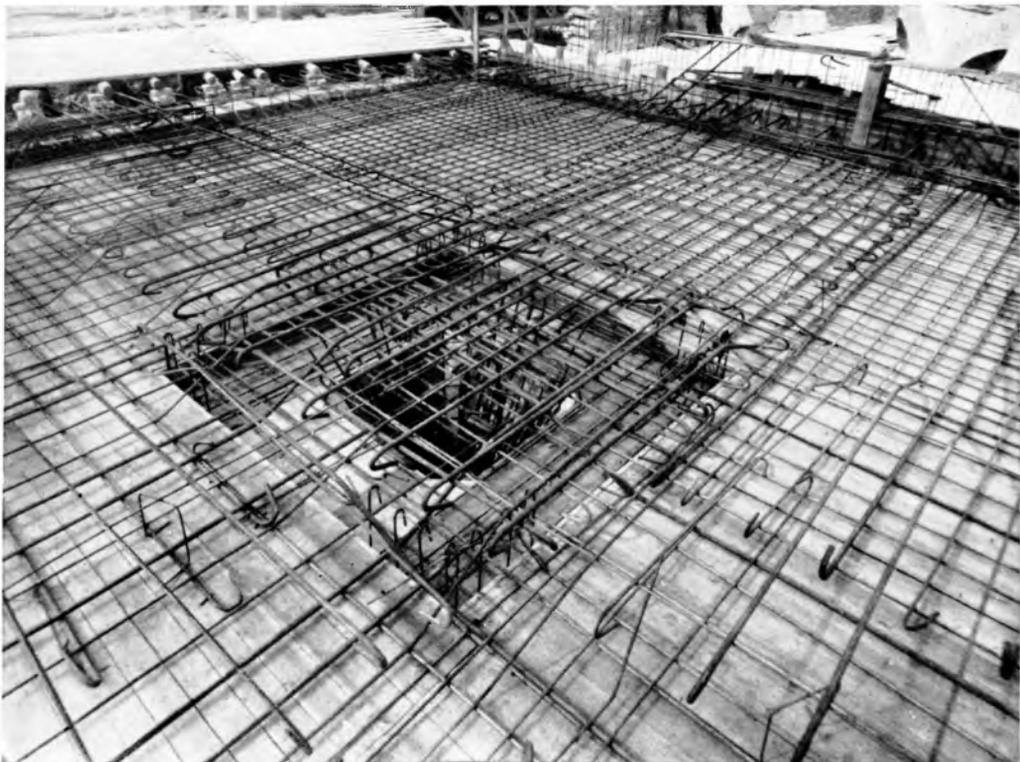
Pilzdecke über der Kantine; fertig geflochtene Bewehrung
